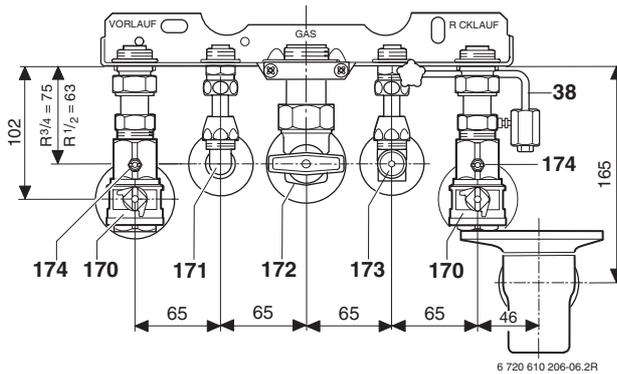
Montageanschlussplatte mit Unterputz-Installation (fertig montiert)
